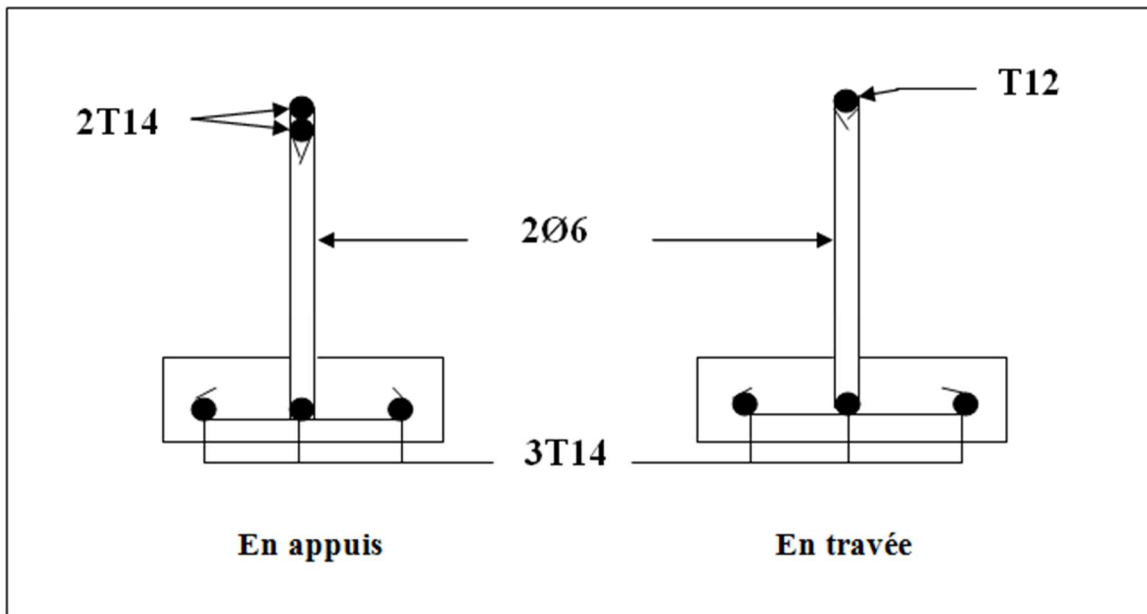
Schéma de ferrailage des poutrelles en travée, et en appuis
